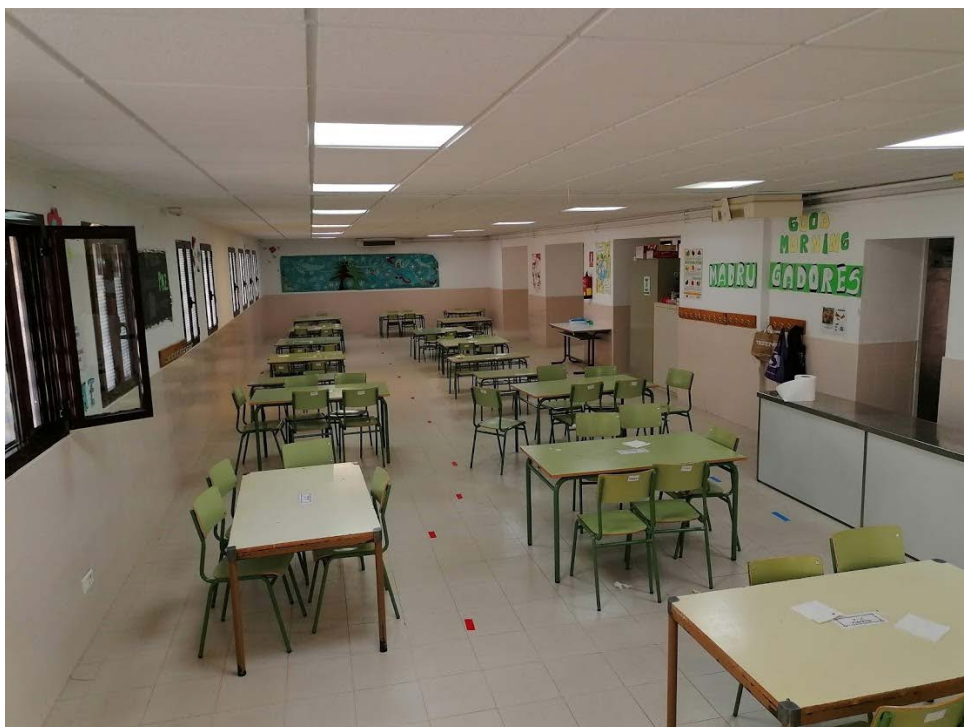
Vista del comedor. Al partir de las cocinas está el forjado de doble vigueta prefabricada de hormigón con bovedilla. Al fondo por las aperturas de la derecha que dan al patio está el forjado bajo el pasillo de viguetas prefabricadas de hormigón adosadas.
